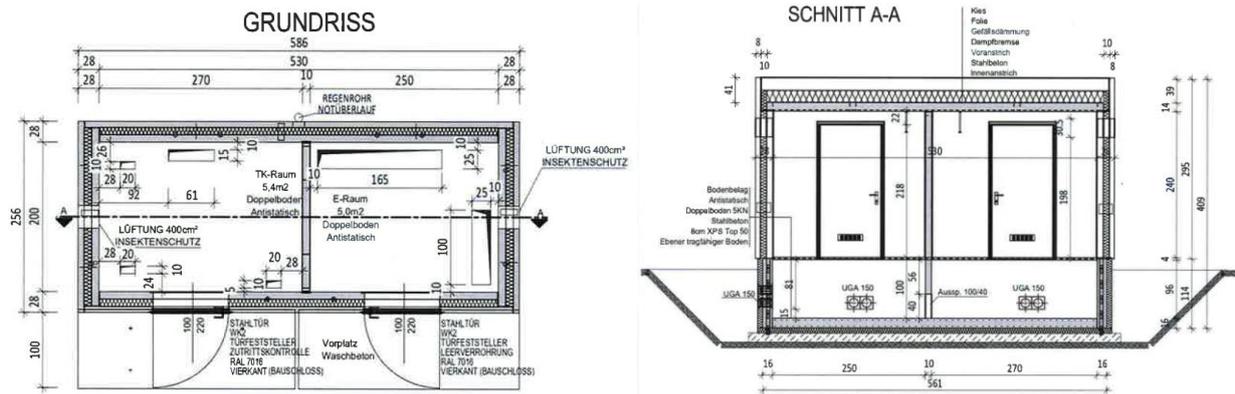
Schalthaus - Grundriss und Schnitt (gem. Bauvorhaben - SH Lödersdorf)
